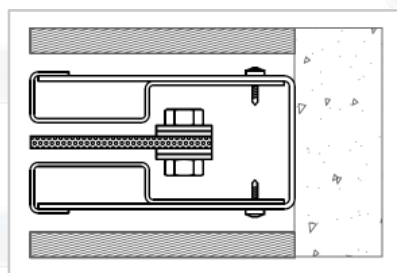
Монтаж на управляваща конструкция в стоманена стена/конструкция
